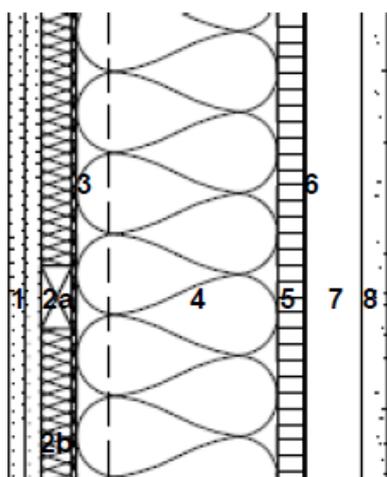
Detailausschnitt Außenwand Dachaufstockung von Fallstudie 2
